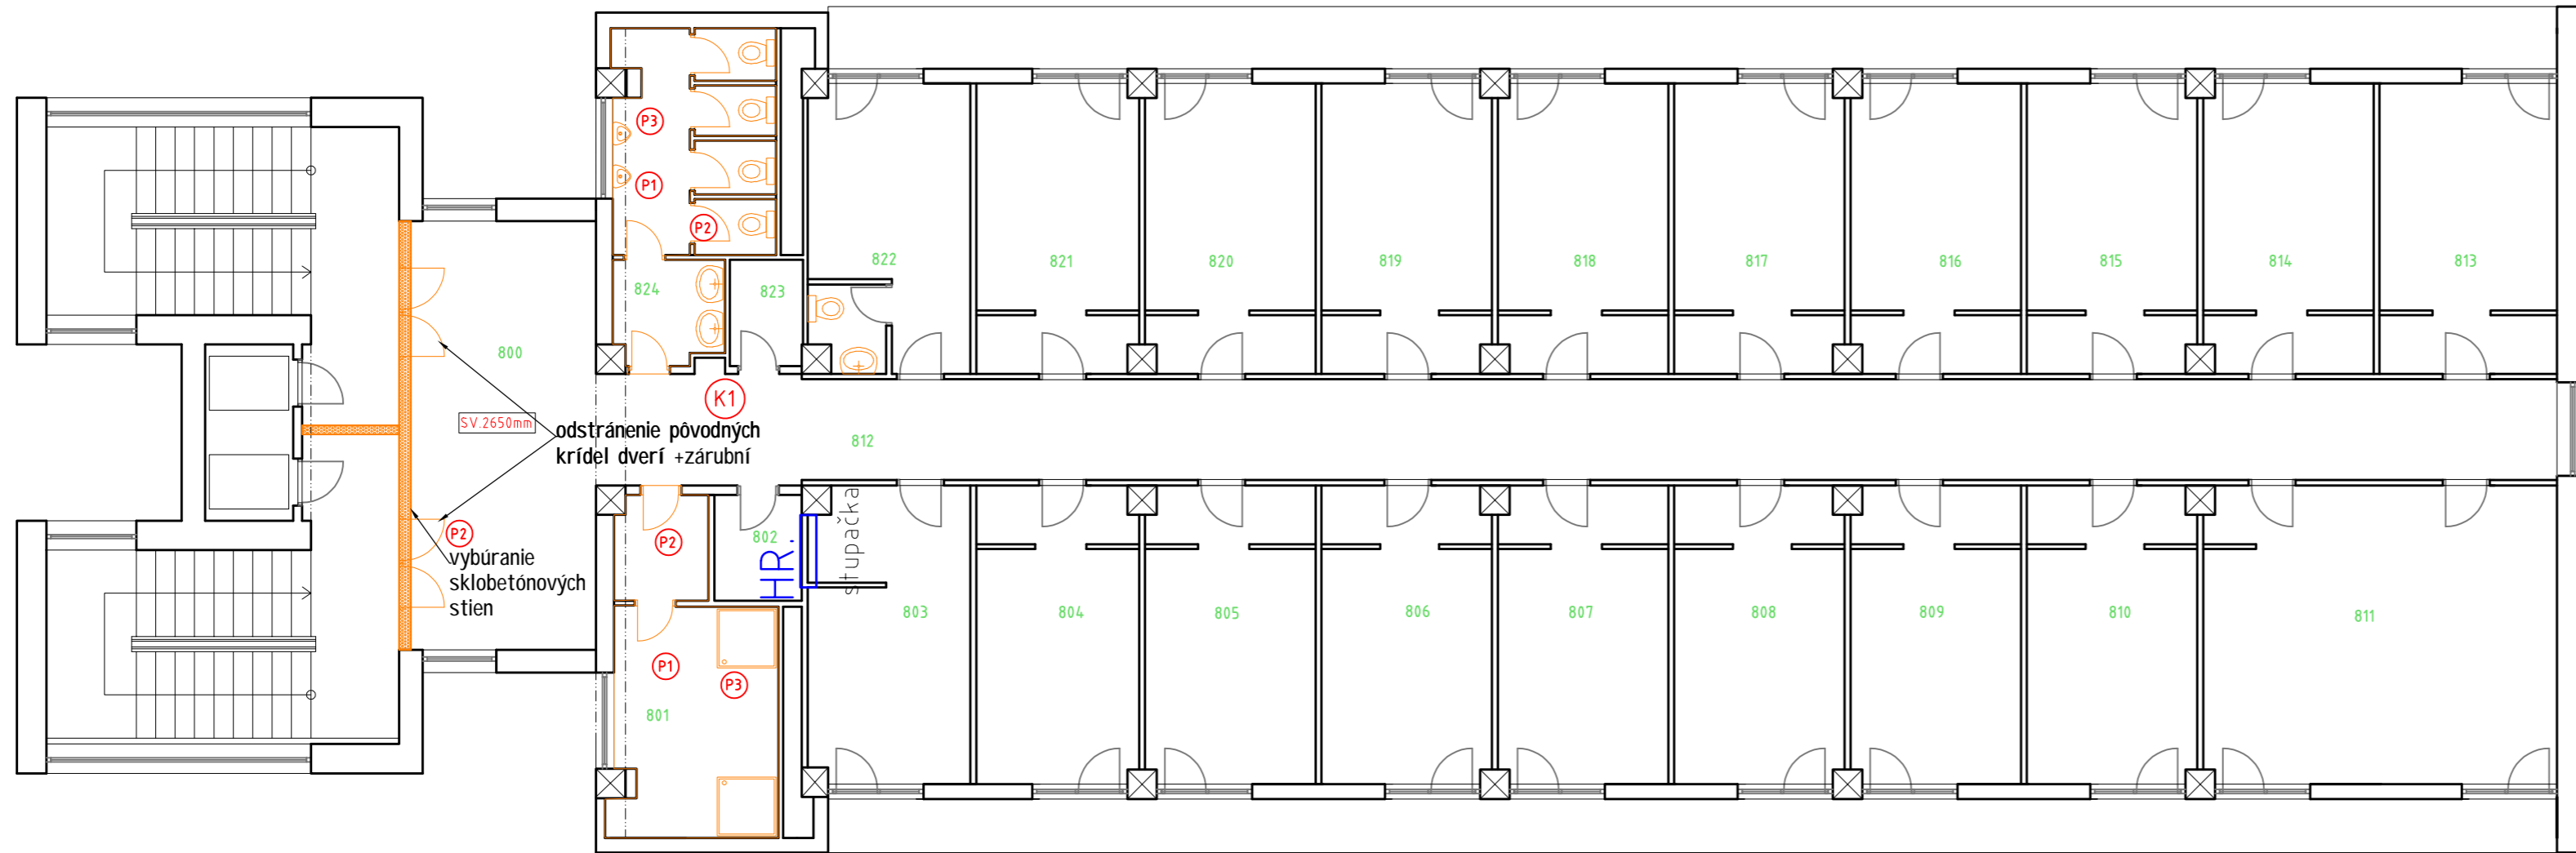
DETAIL WC (+vychov.) 7.NP\_internát m 1:150
